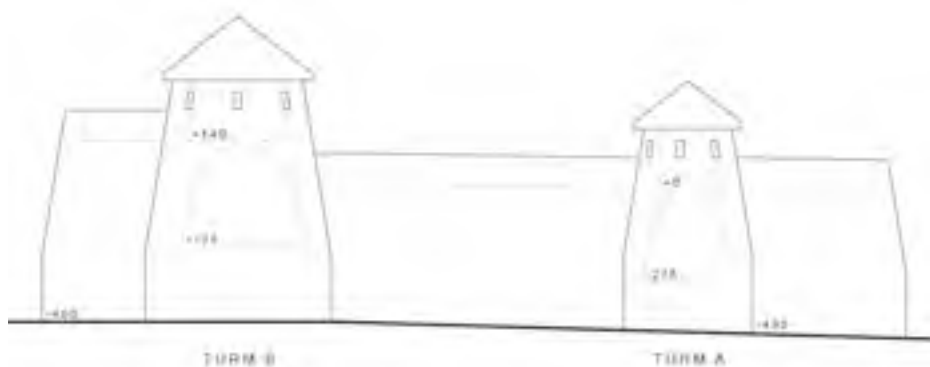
Zambujal, reconstrução da primeira linha de fortificações da Fase 4 (Desenho: F. Arnold).
